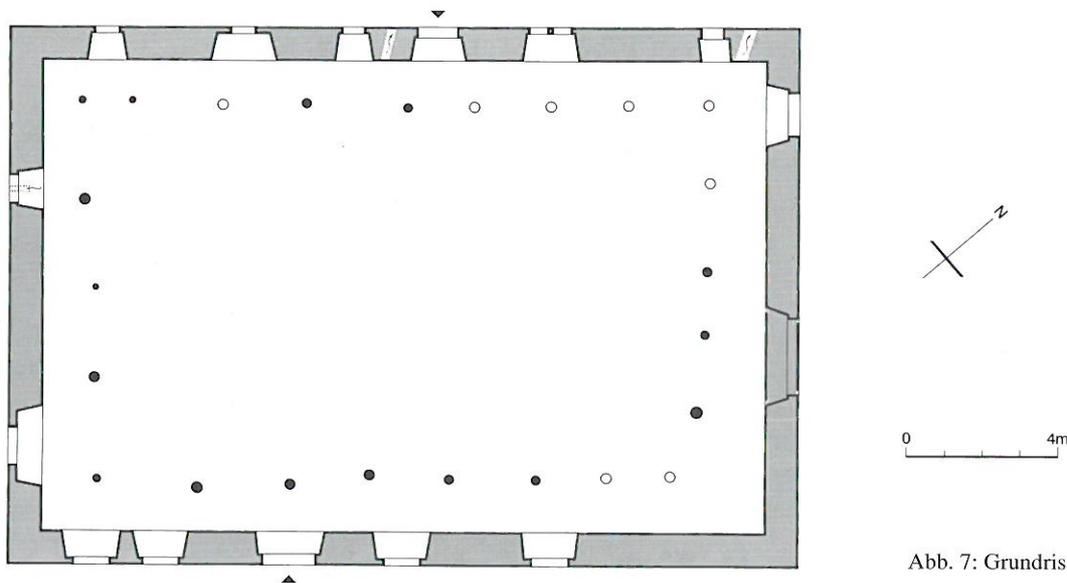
Grundriss mit Pfostenlöchern (1:200).
